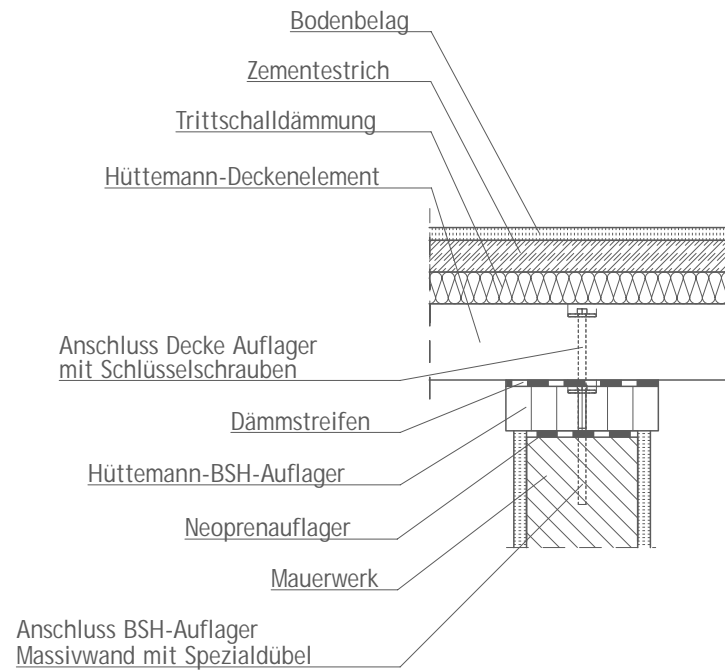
ANSCHLUSS DECKENPLATTE-WANDELEMENT
